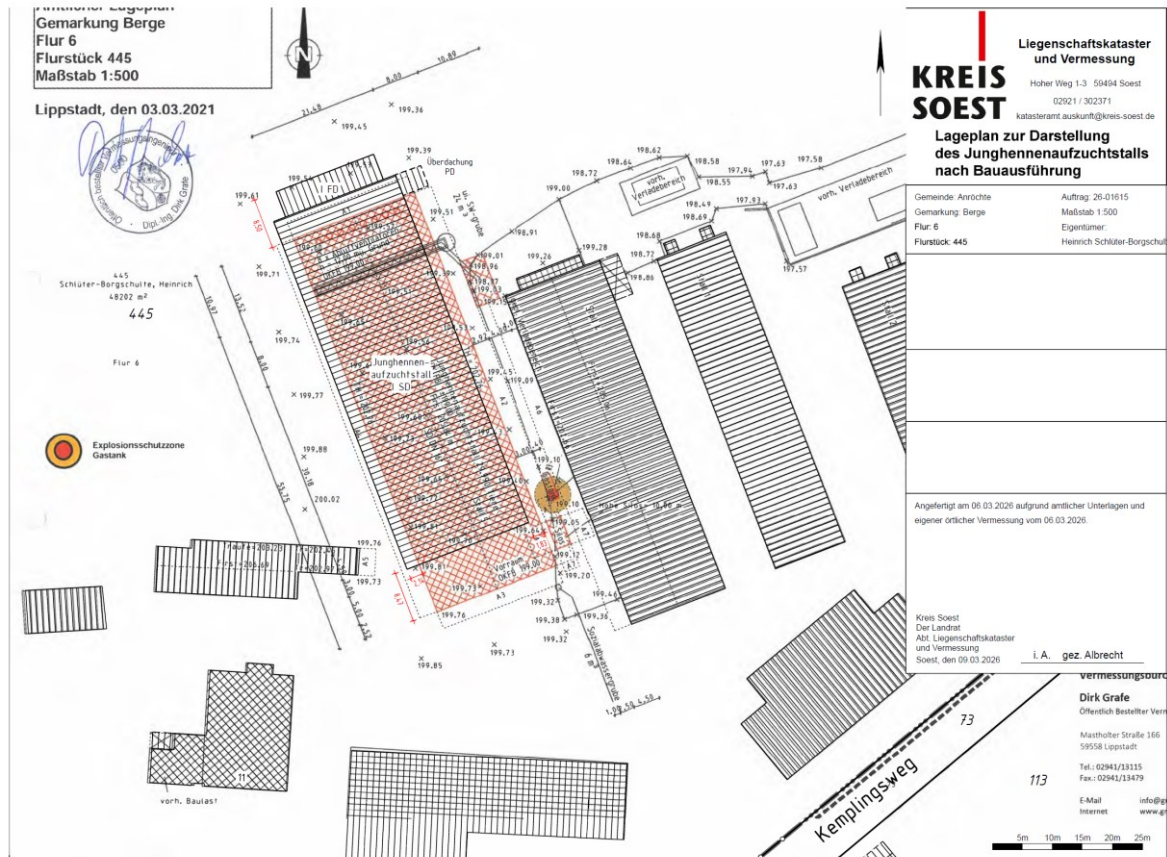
Auszug aus dem amtlichen Lageplan - ohne Maßstab (nach Errichtung)
